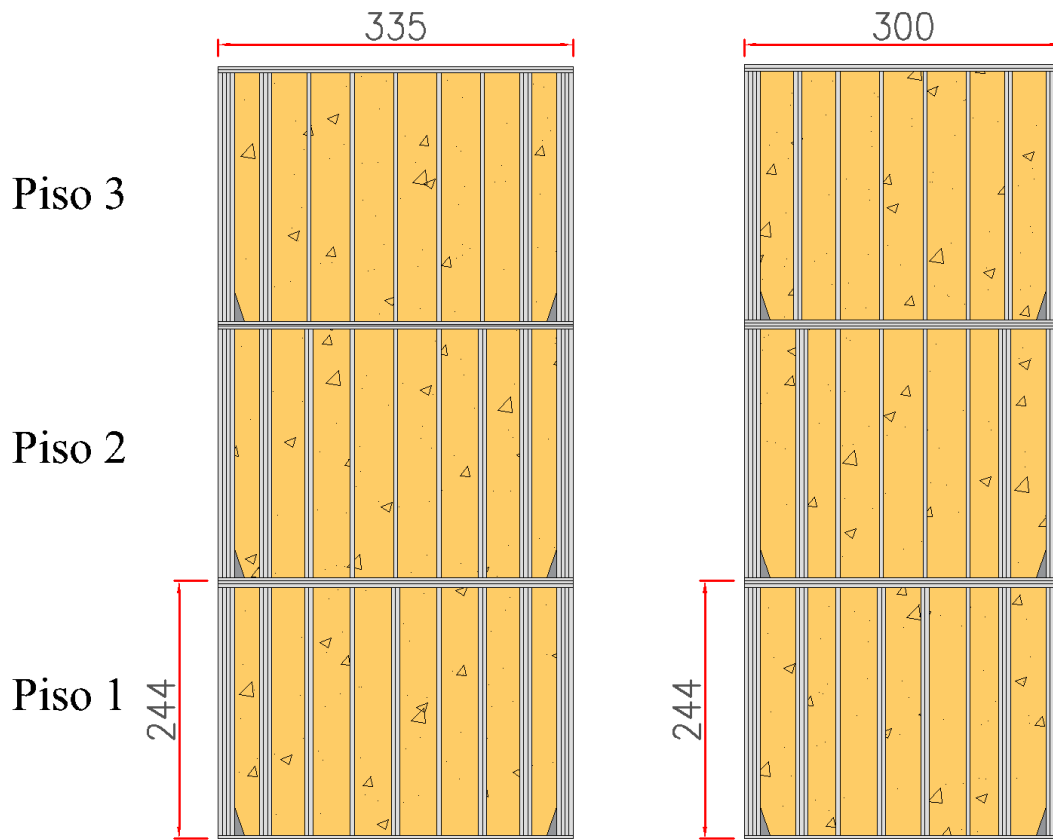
Elevación muros M1 y M2, respectivamente (medidas en centímetros).
